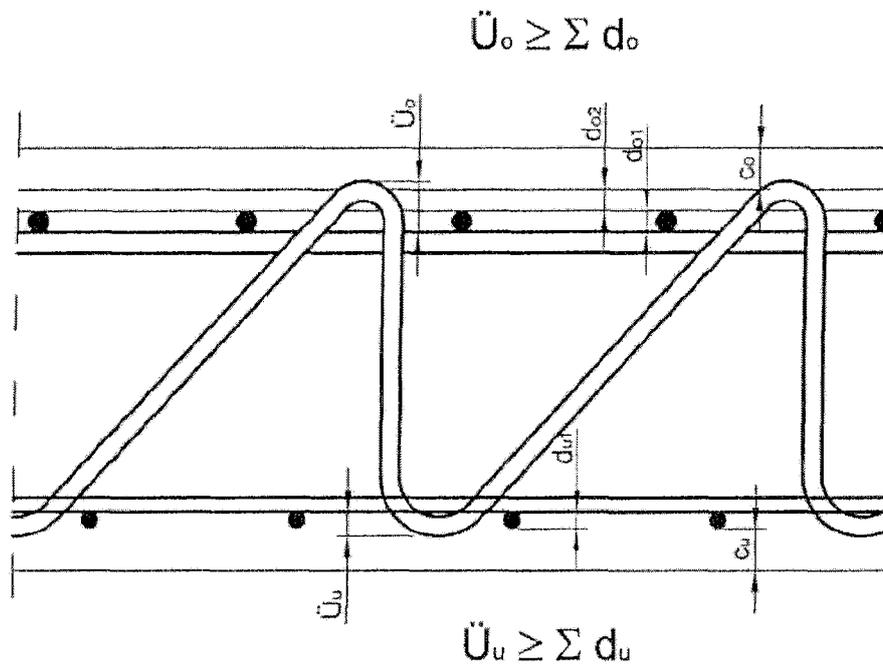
FILIGRAN - Durchstanzbewehrung und Biegebewehrung
